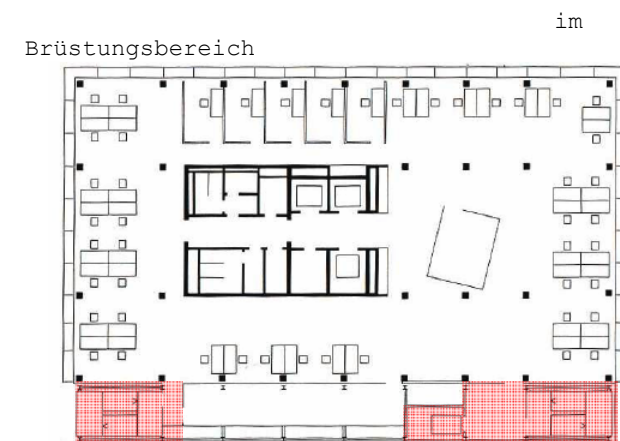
Regelgeschoss - Grundriss 1.0G (Quelle: Baumeister 6/03)
